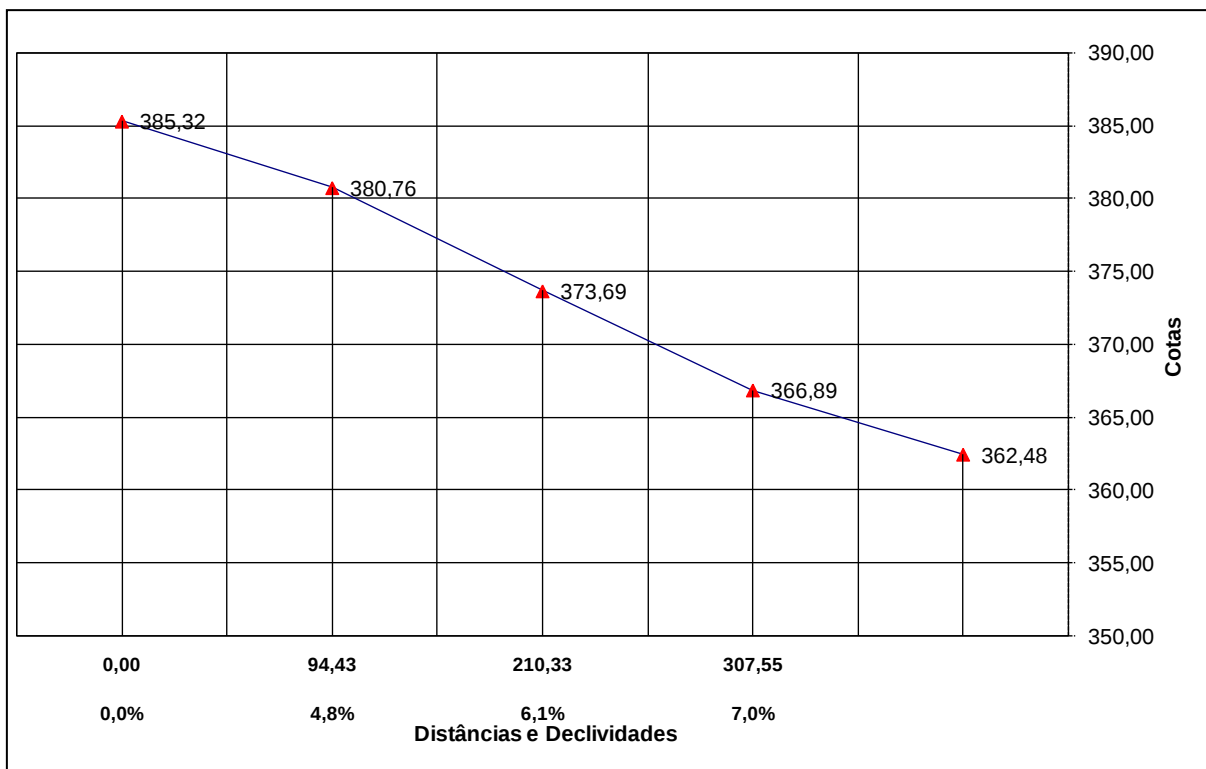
Perfil longitudinal do canal 2 (sem escala).
